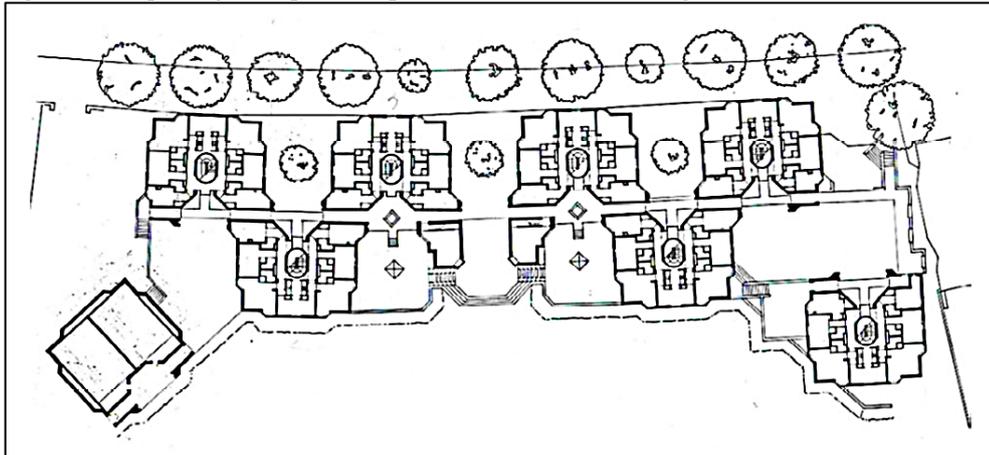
Planta do Pavimento Tipo do Balliol College, Reino Unido
